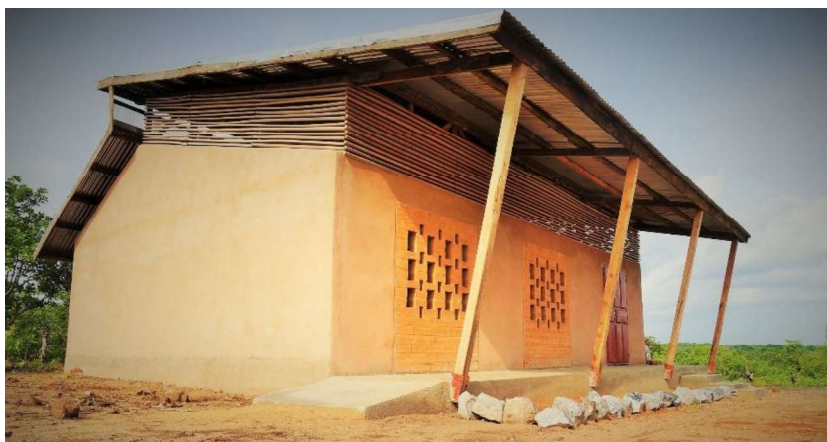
Prototipo pedagógico construido en mampostería portante de adobe, muros perforados en BTC y revoques en cal y arena. Cubierta dilatada en bambú de rafia
